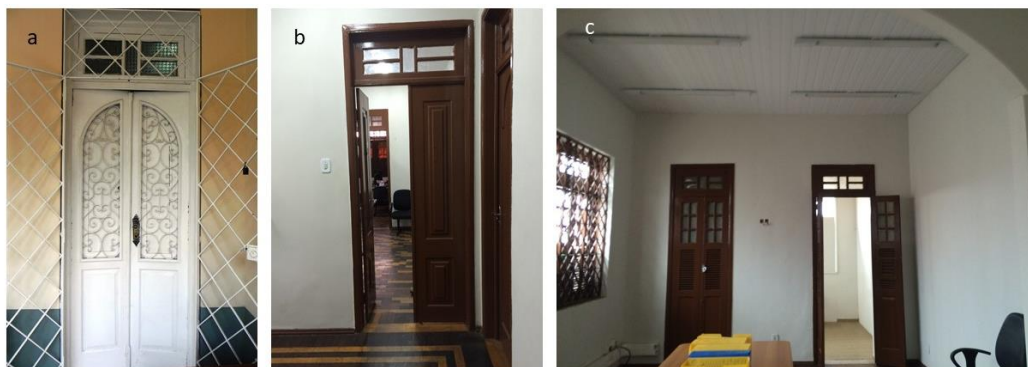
Portas: fachada principal (a); pavimento superior (b, c). Fonte: autora, 2015.
